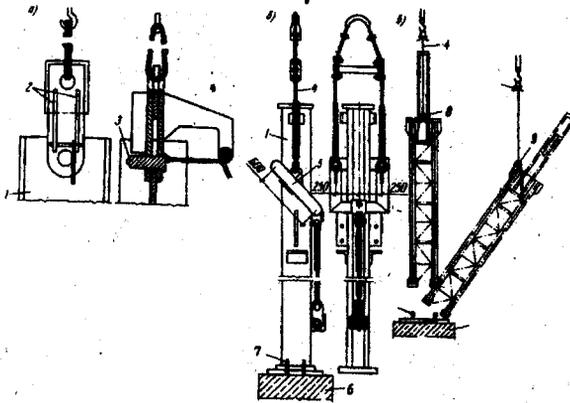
Металл устунга осма зина ва сўриларни ўрнатиш.
